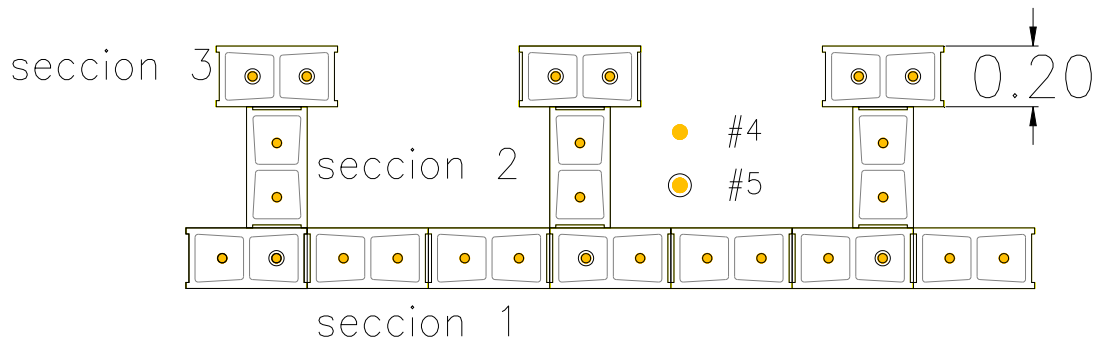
Sección transversal, típica a lo largo de 7 m, vista en planta
